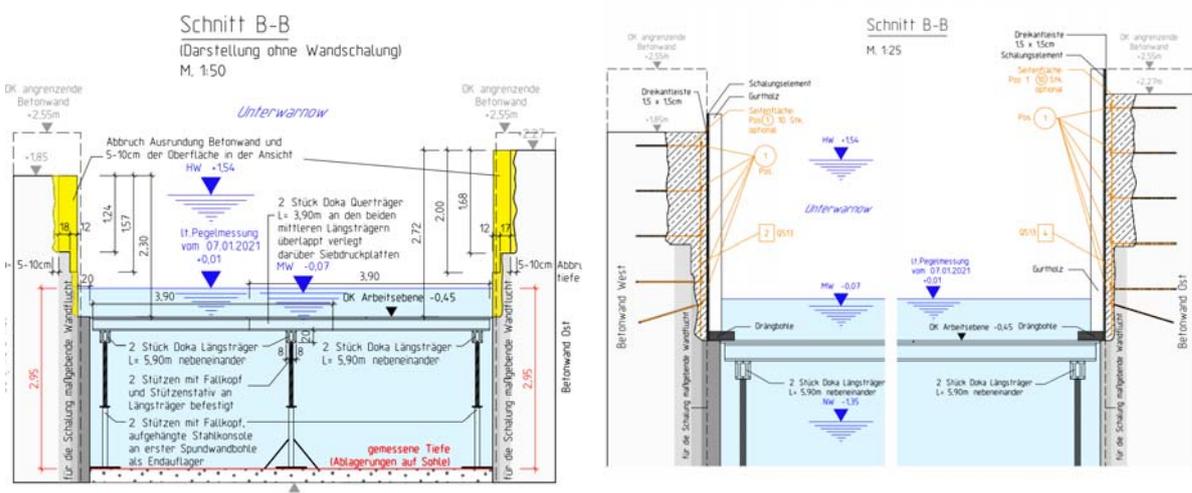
Sanierung der Betonwände unterhalb der Mühlendammbücke (WSV, April 2021)
